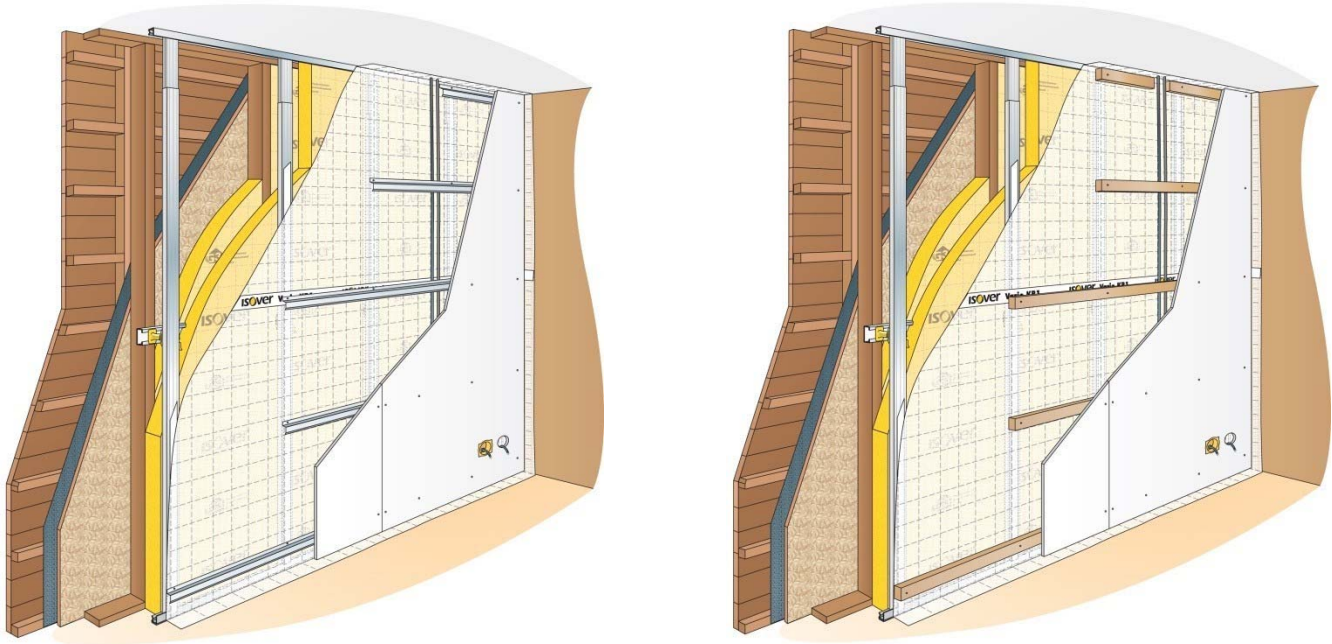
Pose du parement sur une ossature rapportée sur l'ossature secondaire métallique.
